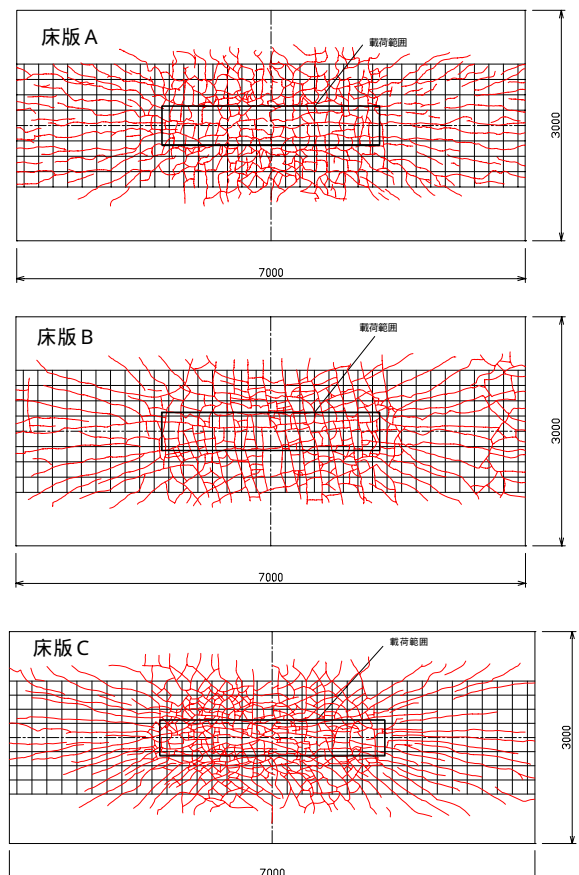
破壊時の床版下面のひび割れ状況
